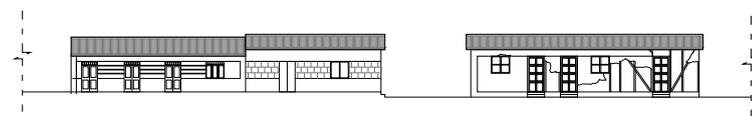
Fachadas viviendas calle Los Libertadores, Chañaral Alto, 2019.
